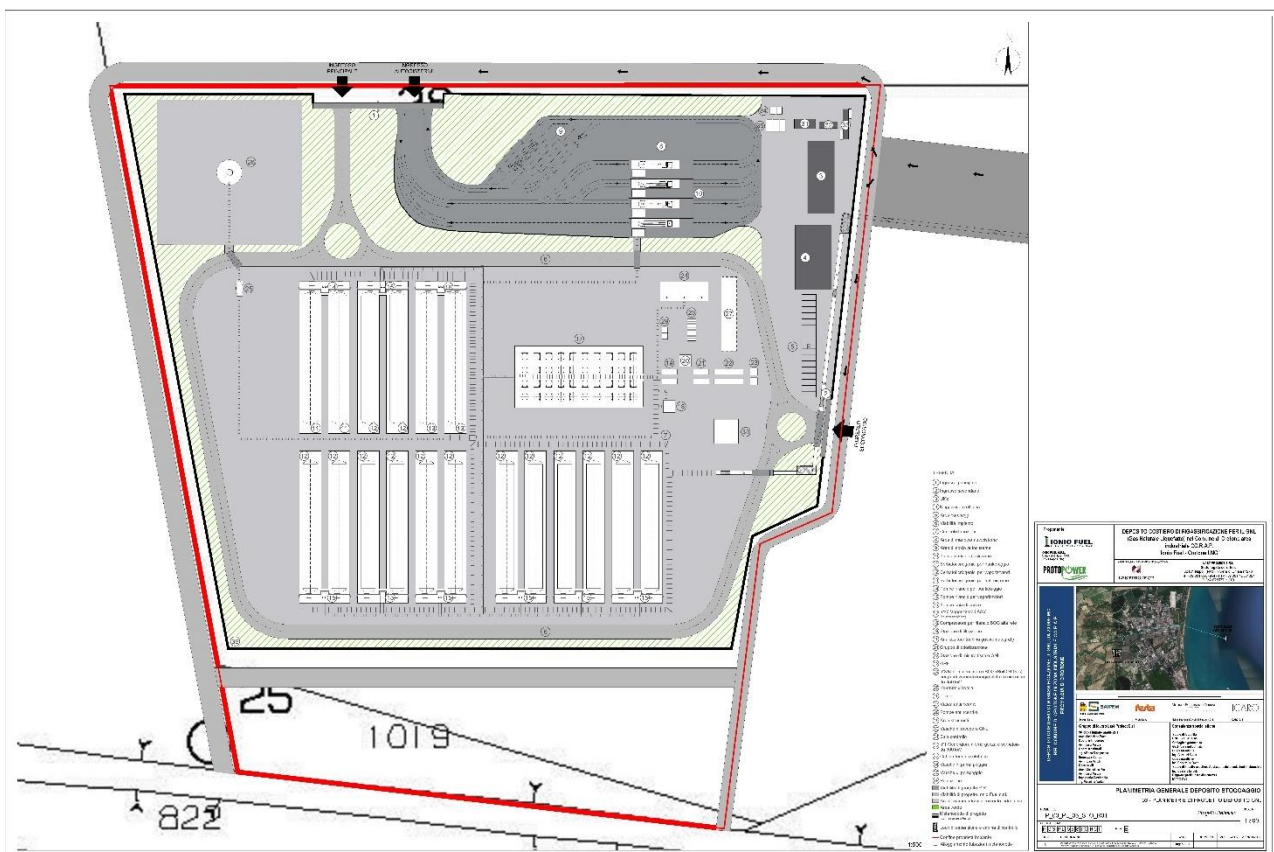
P_03_PL_05_STO_R01 Planimetria generale Deposito di stoccaggio
